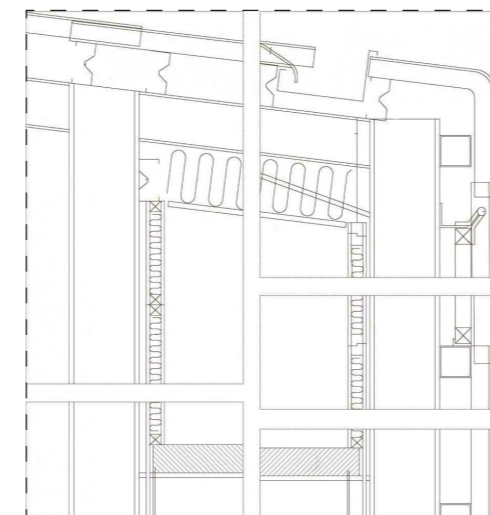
Detalle constructivo Casa Latapie. Lacaton y Vassal.
